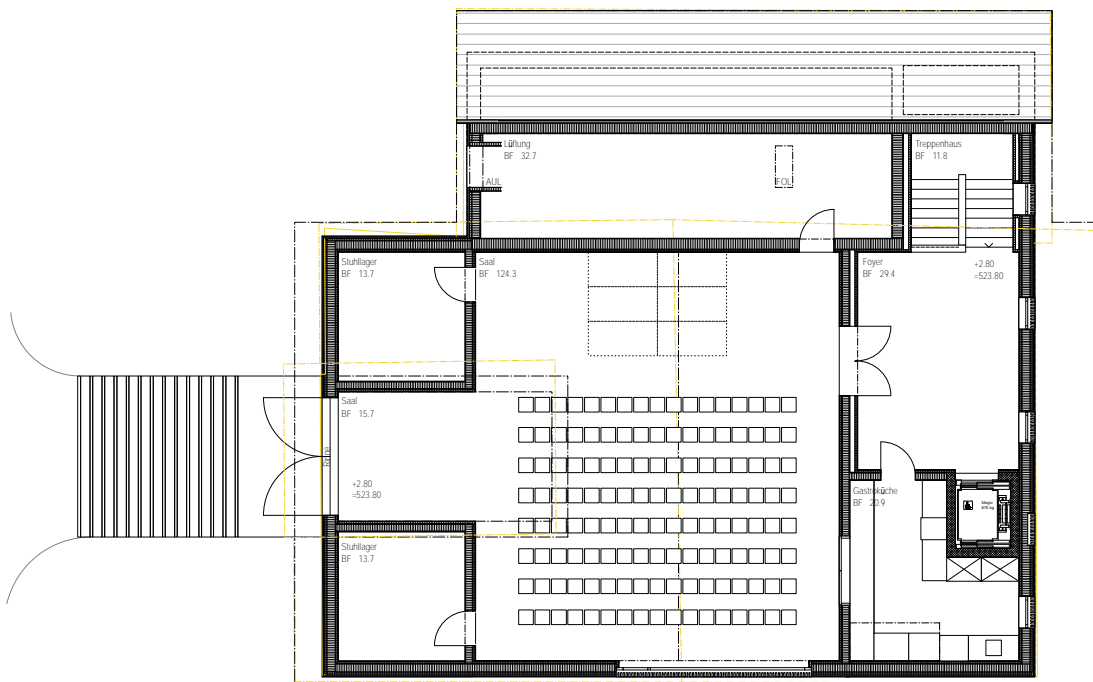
; Grundriss Mehrzwecksaal, Bünzli & Courvoisier Architekten AG
